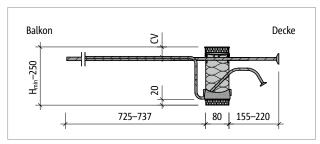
Schöck Isokorb® T Typ K-U-M2: Produktschnitt
